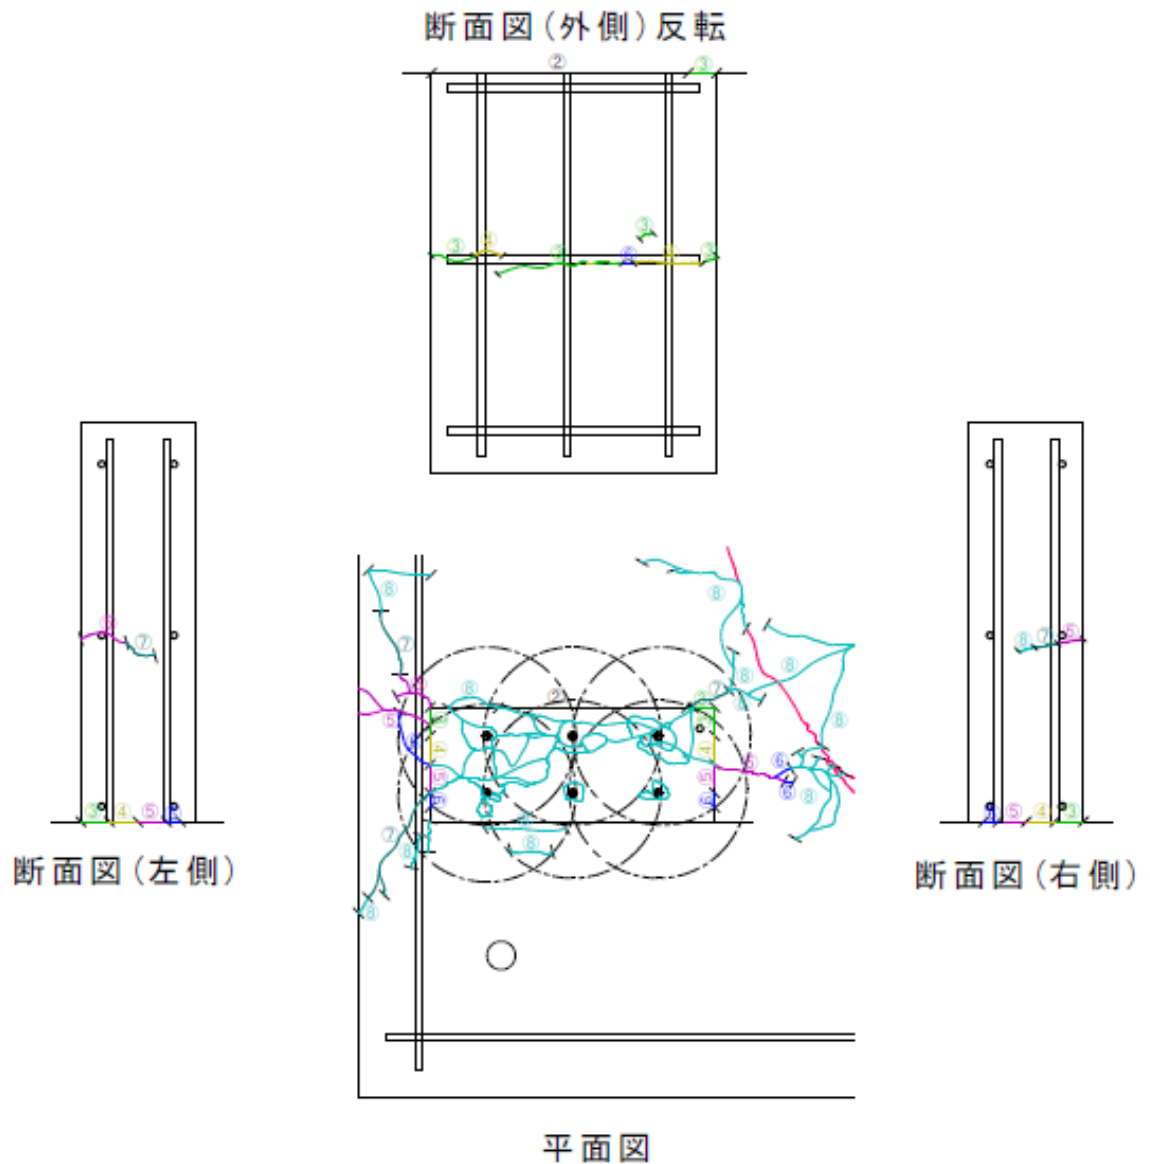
ひび割れ図および最終破壊状況写真 (No.4L)
